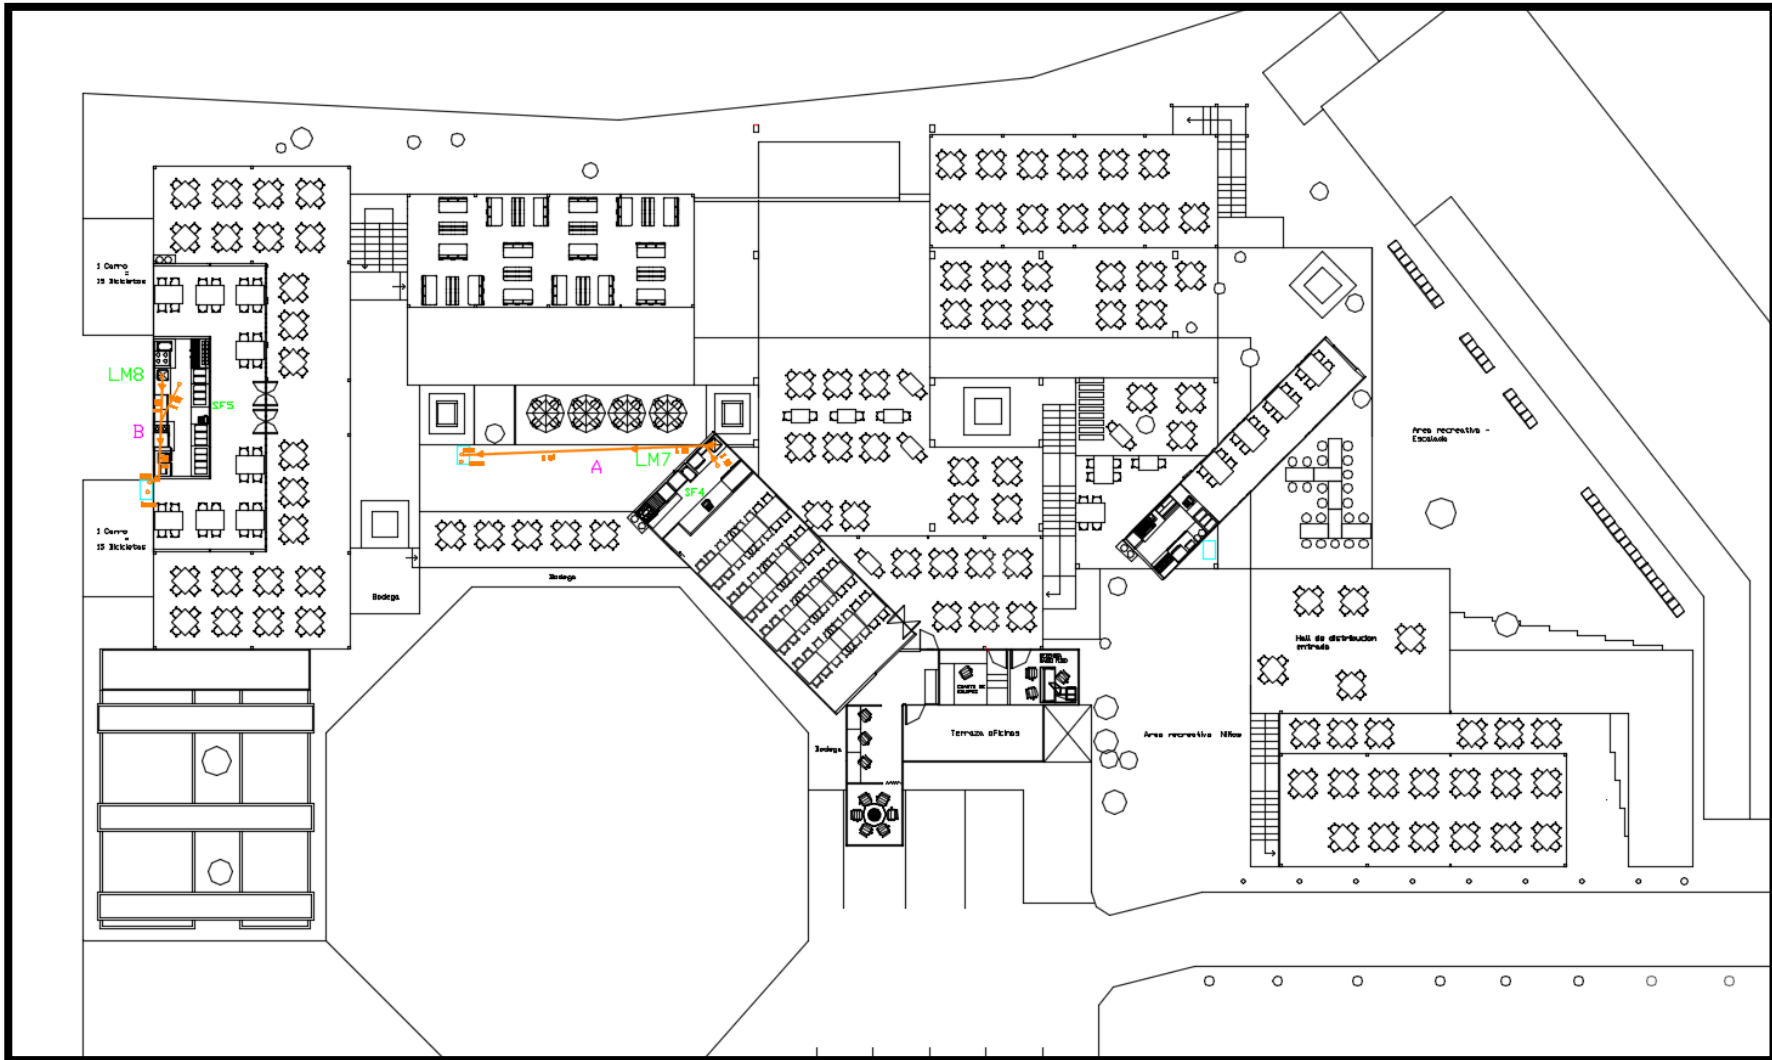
Vista en planta de la red de desagüe del 2do piso de La Galería
